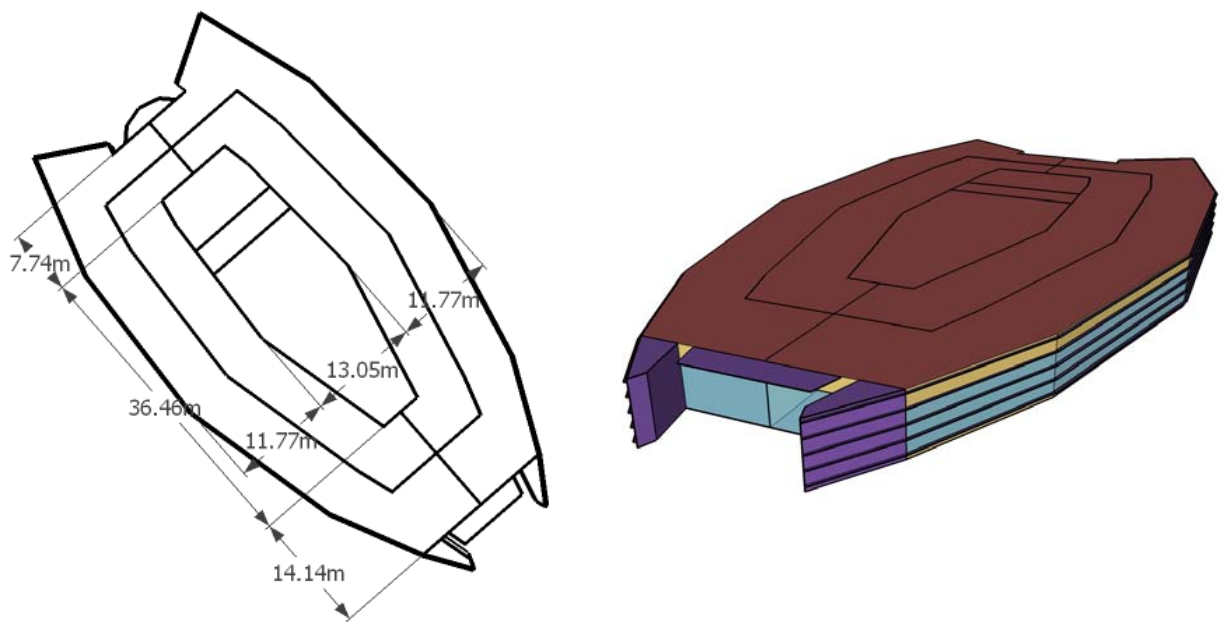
Planta e modelo espacial de pavimento tipo do Proposed Building para o estudo de caso #3
